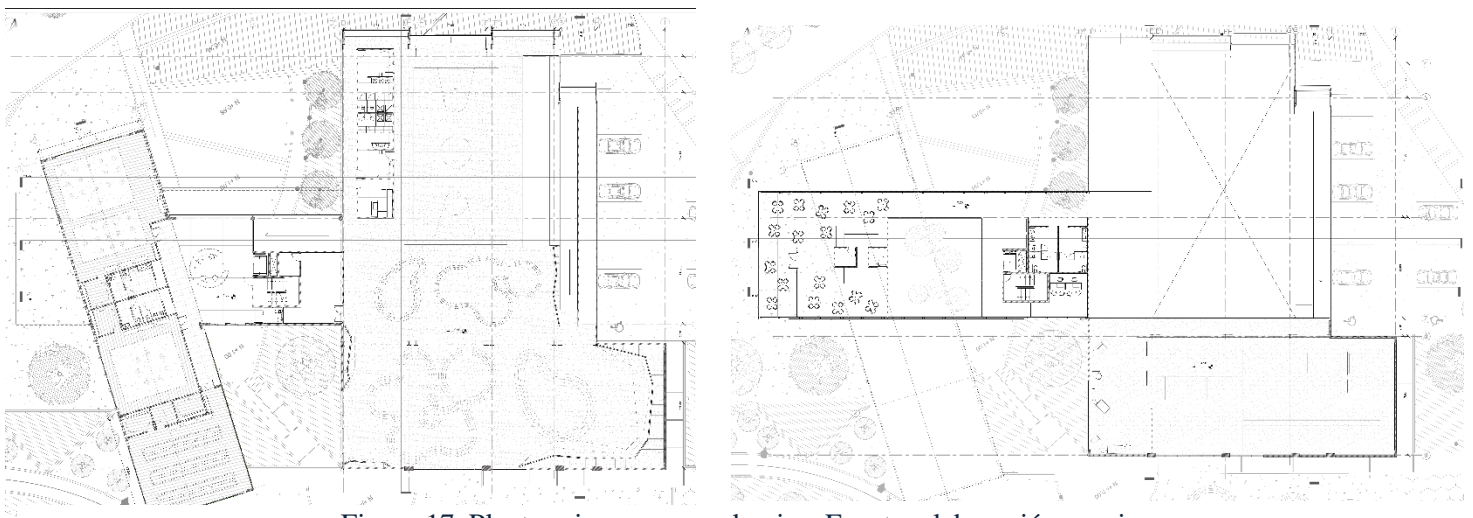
Planta primer y segundo piso. Fuente: elaboración propia
